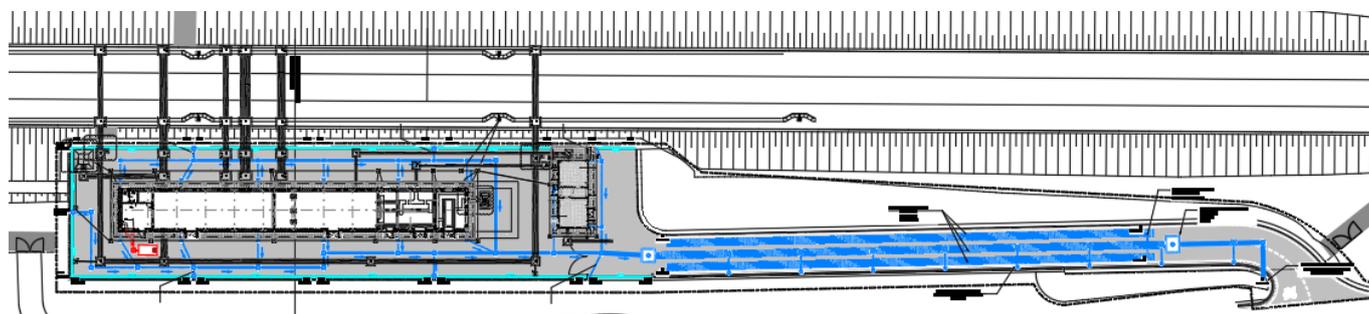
Estratto planimetrico dello stato di progetto – Individuazione dell'area oggetto di intervento con polilinea tratteggiata nera.
